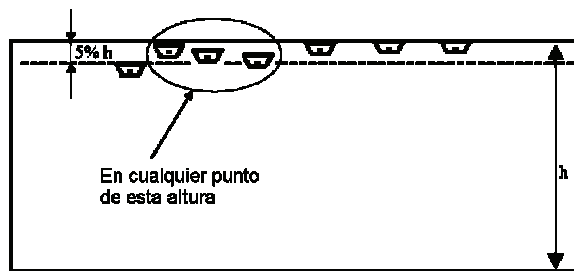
Emplazamiento y separación bajo falsos techos.
